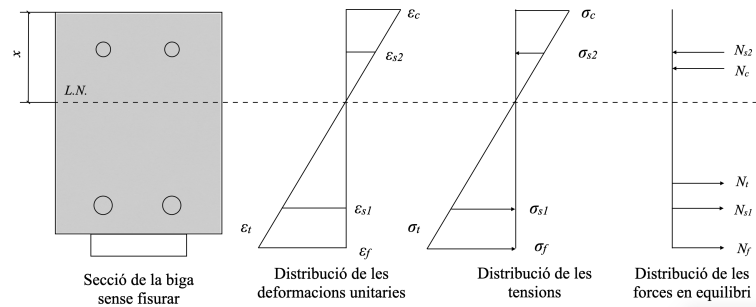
Anàlisi seccional de la biga sense fissurar.
